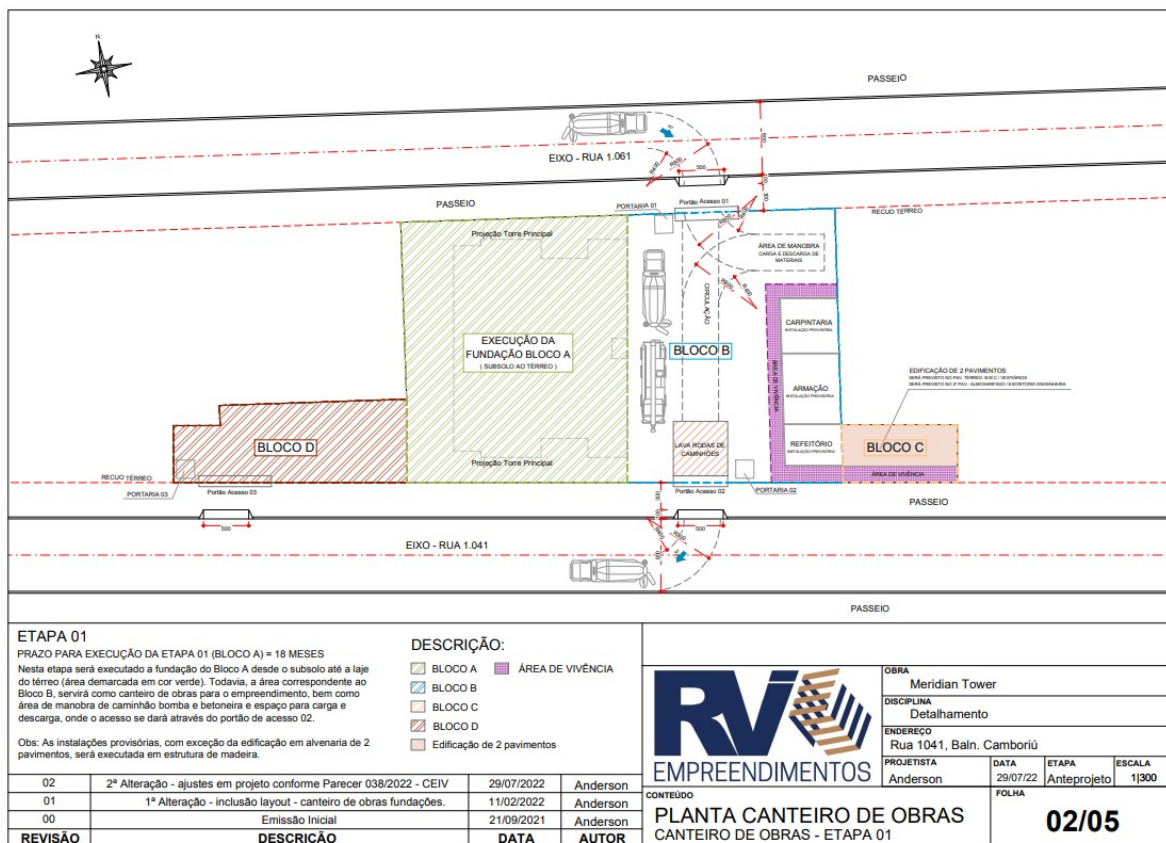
Projeto do canteiro de obras. Prancha 02/05
